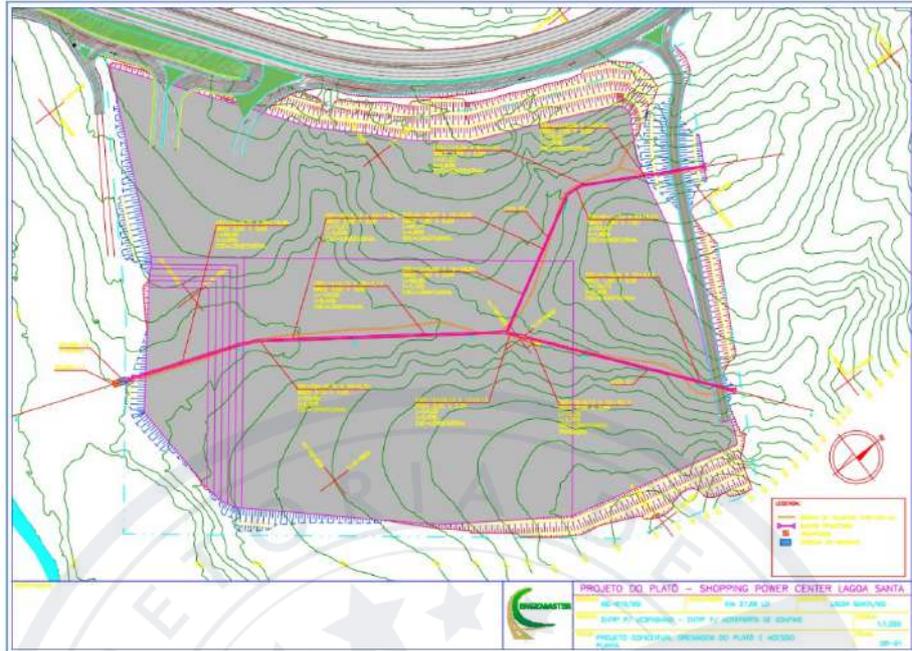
Projeto de drenagem implantado para a área do empreendimento. Processo nº 2900-23-LST-LIC.
